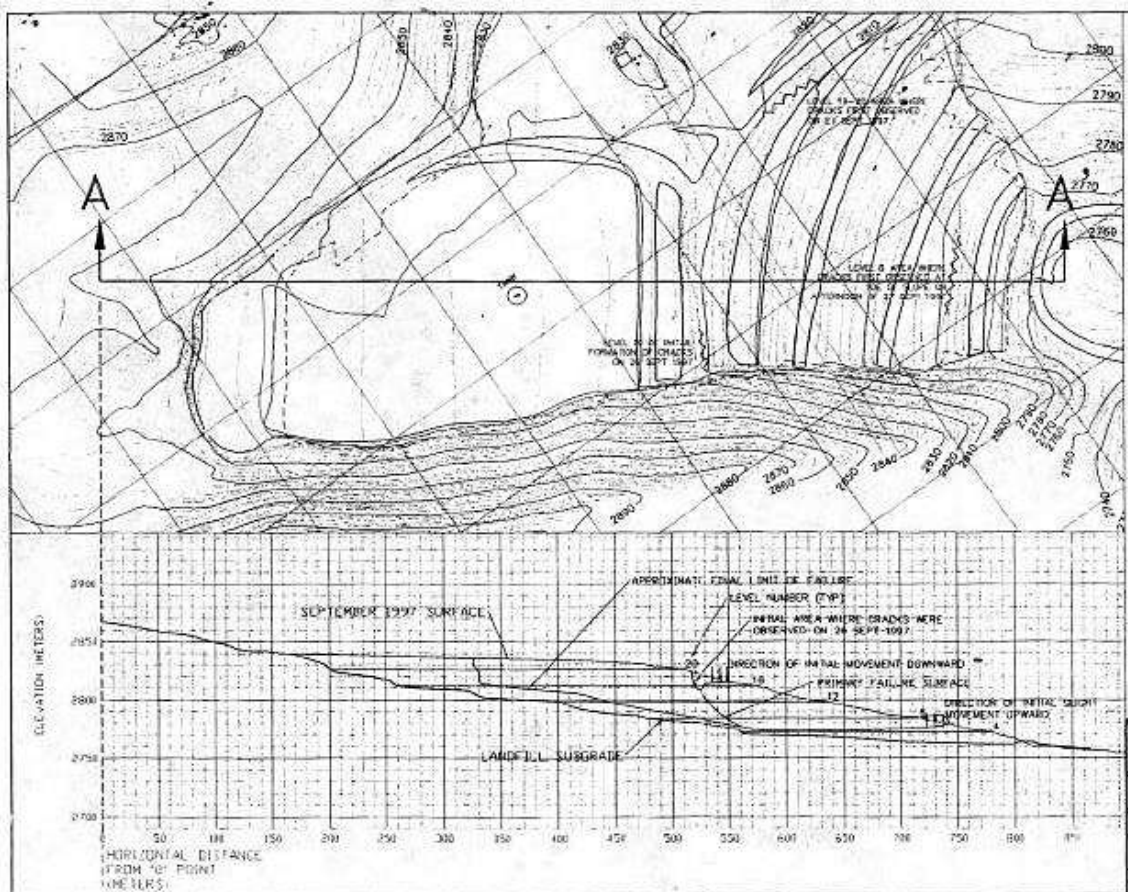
Planta y Perfil de la Zona II- Superficie de Falla - Tomada de Geosyntec (1998)
